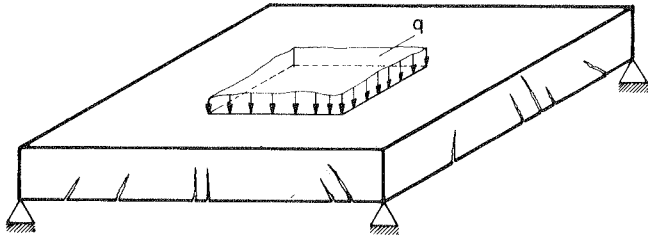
Gerissene Stahlbetonplatte, Zustand II
